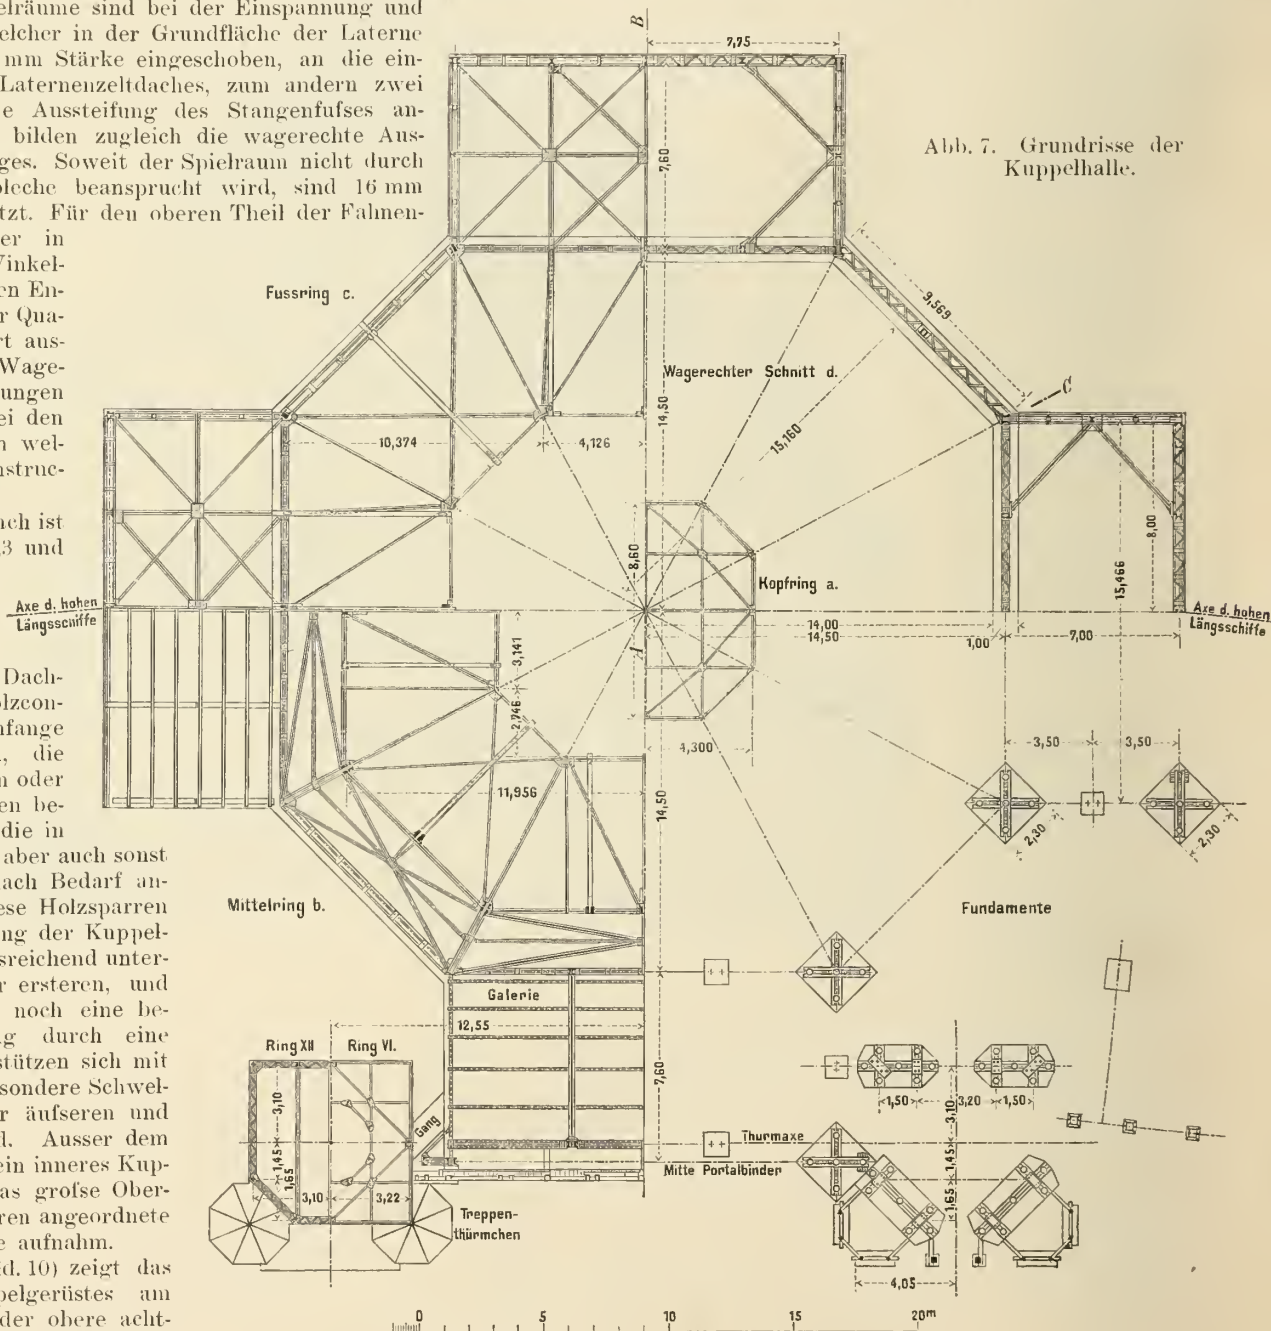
Grundrisse der Kuppelhalle.
